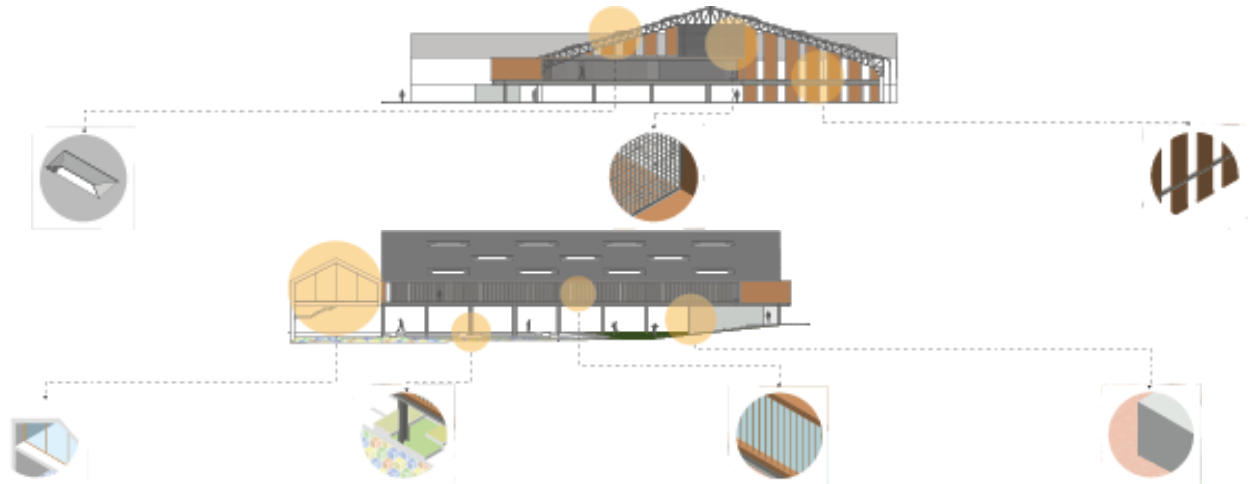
Envoltentes Utilizadas en la propuesta arquitectónica
